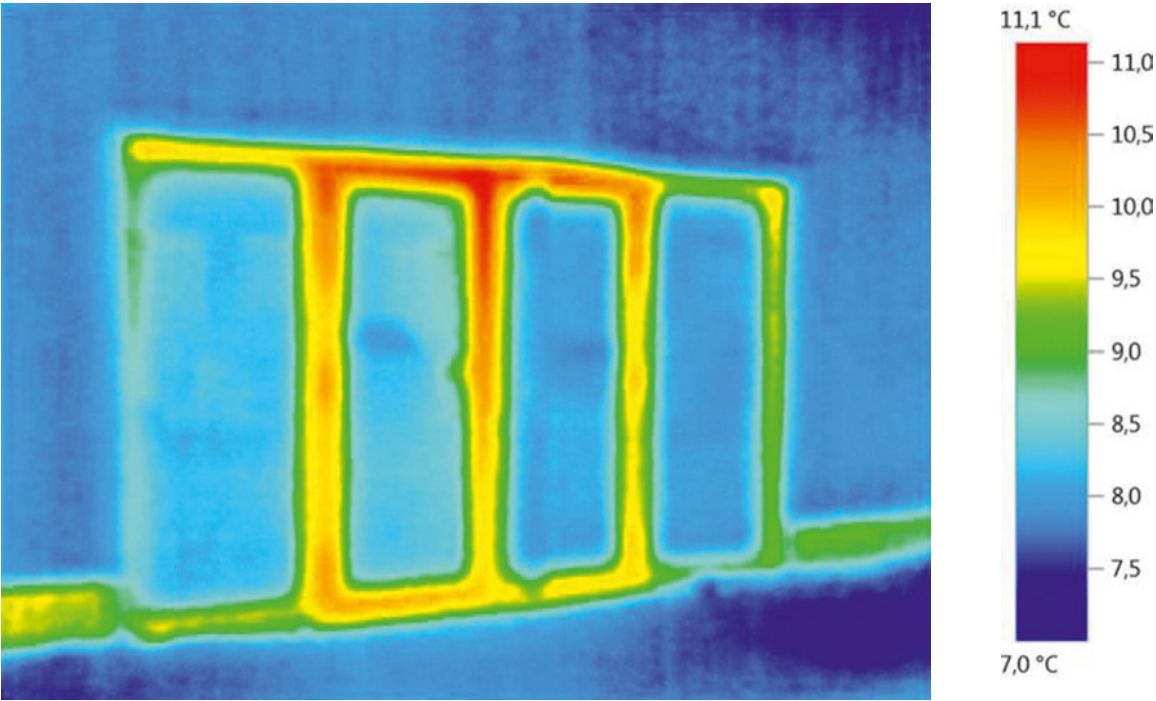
Aufnahme einer Haustür mit Wärmebildkamera [Quelle: PfB – Außentür Halle 2014]
